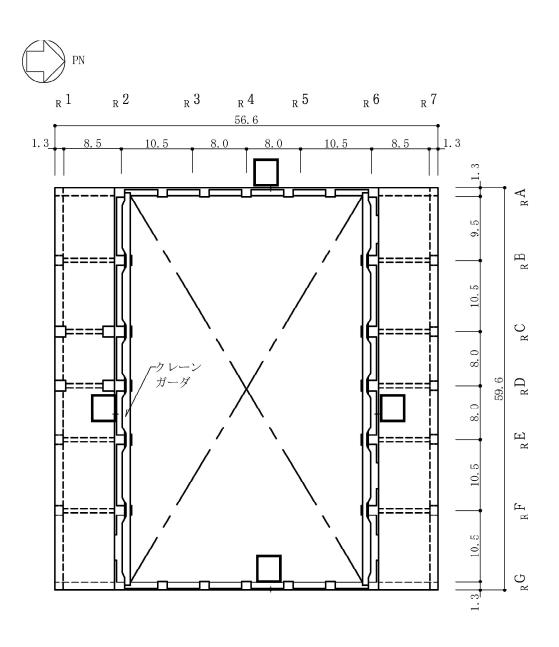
原子炉建屋の概略平面図 (CRF, T.M.S.L.38.2m) (8/9) (単位:m)
